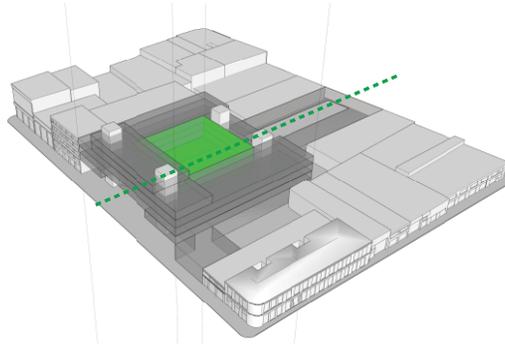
Dirección de eje comercial, axonometría, realizado en sketchup, nov 2016, Elaboración propia
